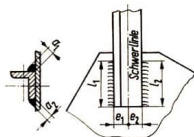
Skizze zur Festigkeitsberechnung der Schweißverbindung
